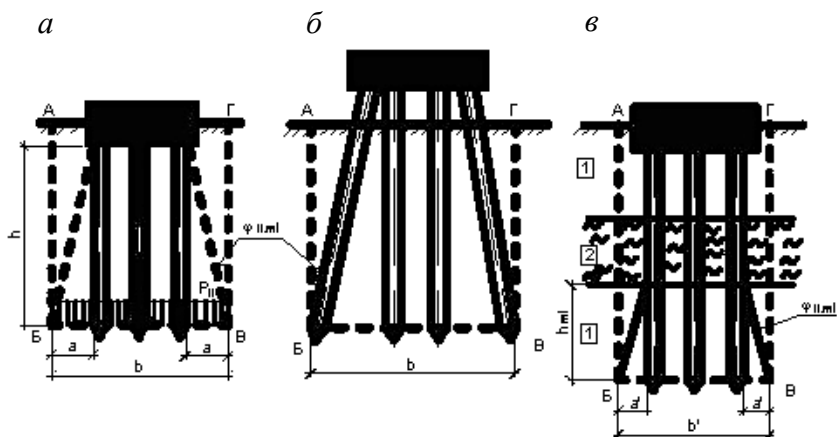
Пример определения границ условного фундамента при расчете осадок свайных фундаментов при наличии свайных грунтов:
